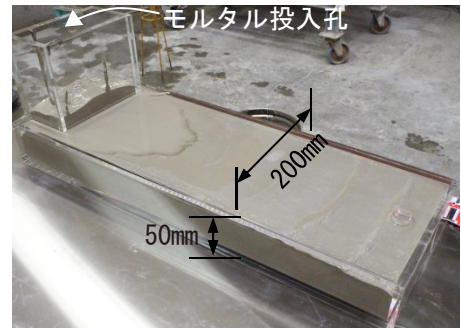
間詰め部の充填状況 写真-2 溶接金網設置状況 写真-3 モルタル充填性確認試験
